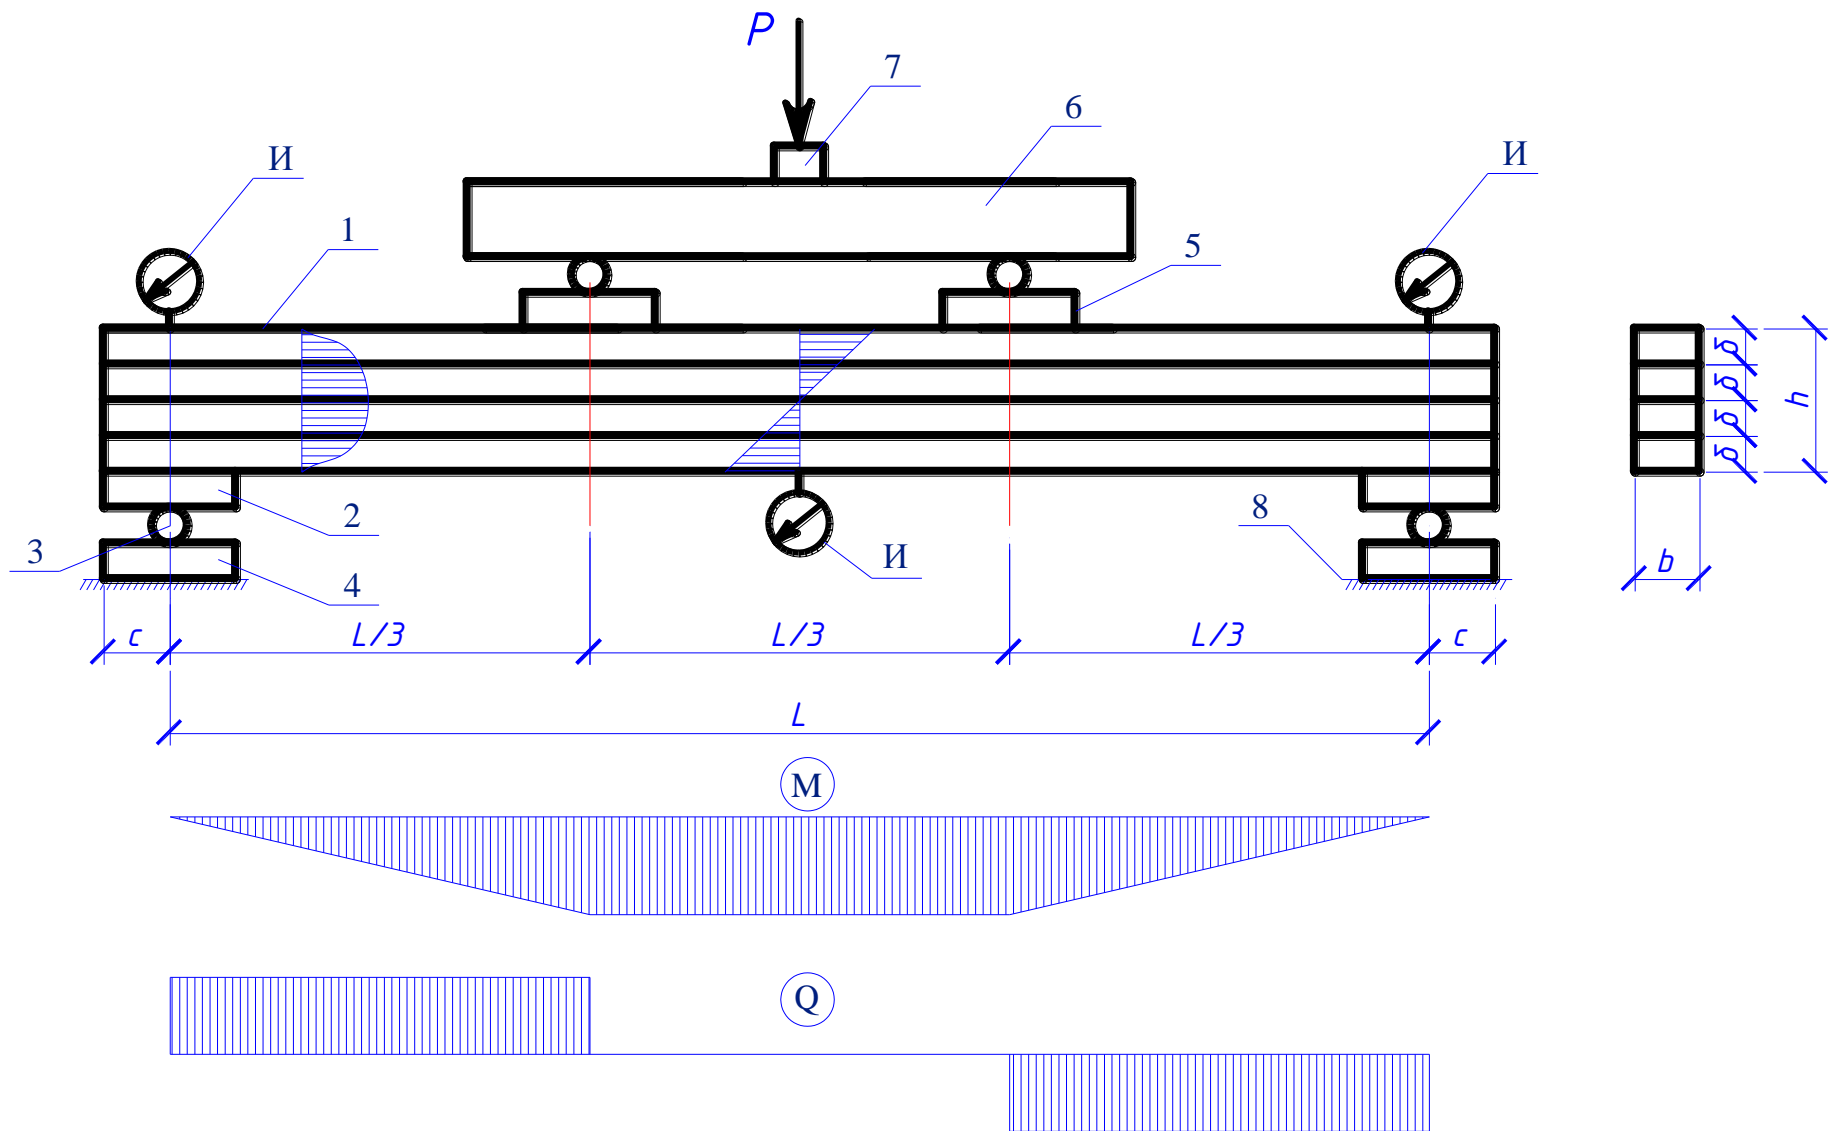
Конструкция и схема испытания на статический изгиб клееной балки:
